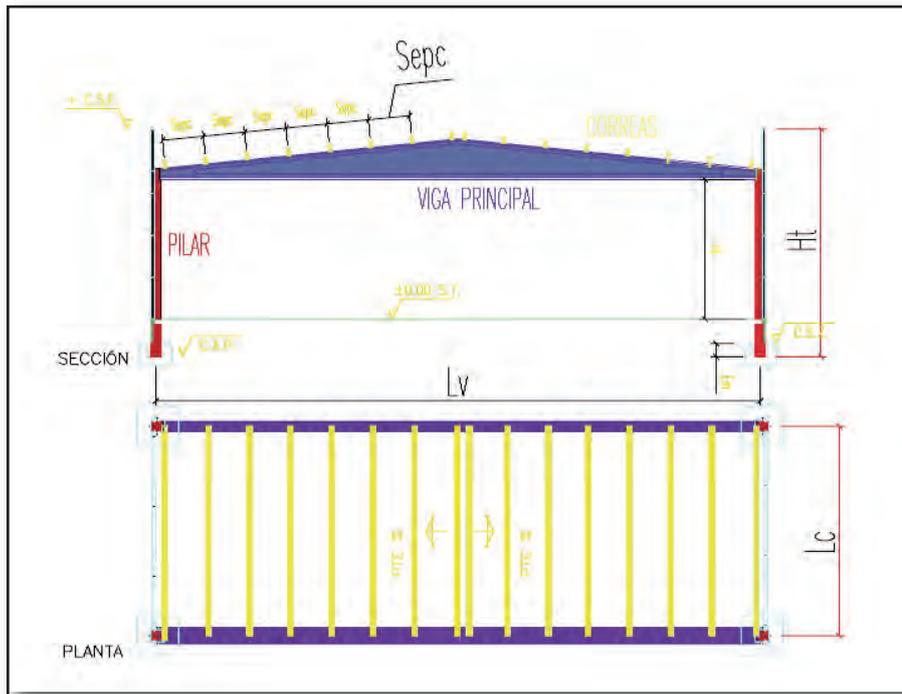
Esquema de los parámetros principales en Estructura Prefabricada de Cubiertas Ligeras
